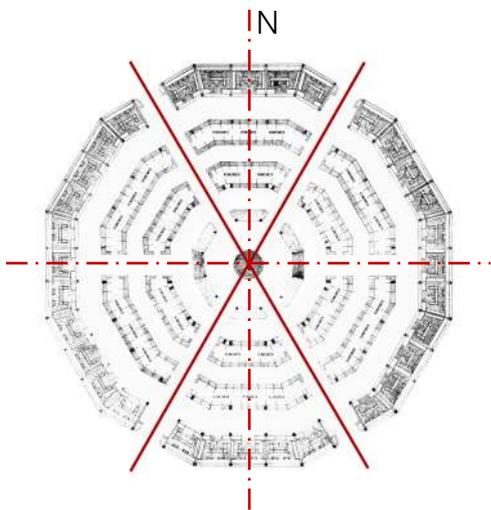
Planta esquemática: eixos estruturantes
